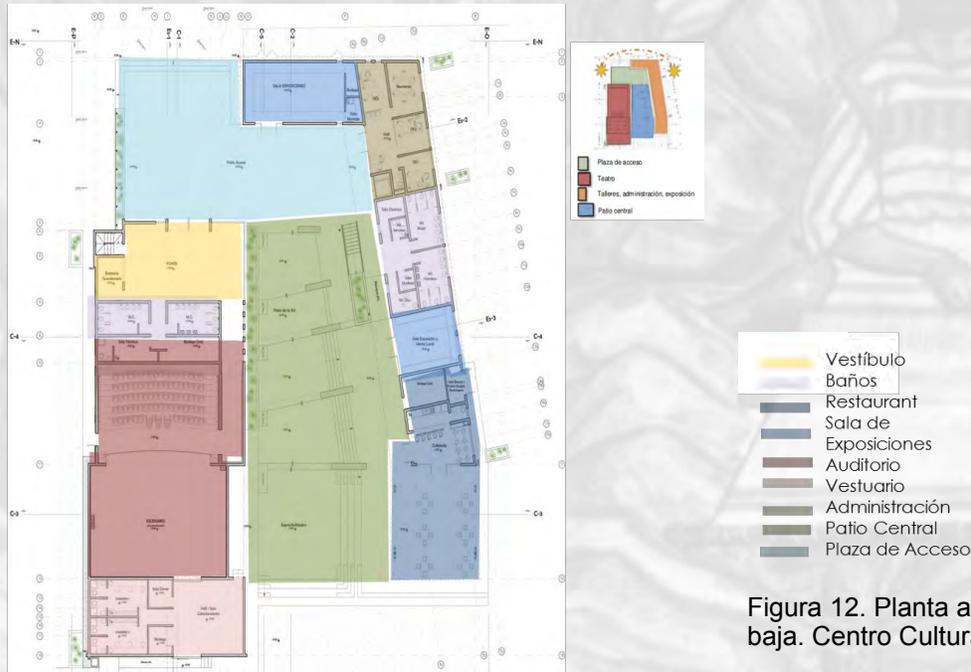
Planta arquitectónica baja. Centro Cultural Alto hospicio.
